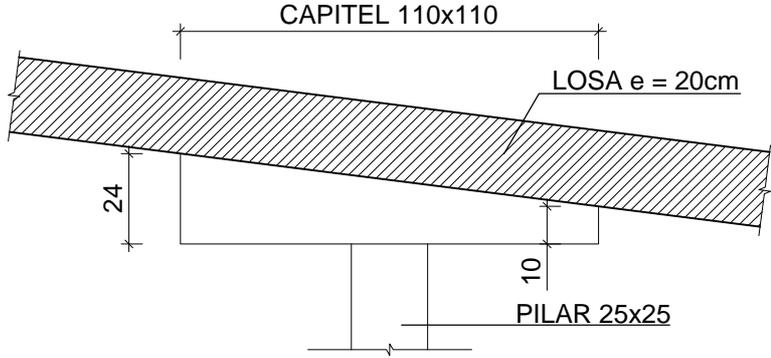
DETALLE DE CAPITEL EN PILARES 4 Y 5 DE LA LOSA DE SUELO DE SALÓN DE ACTOS
